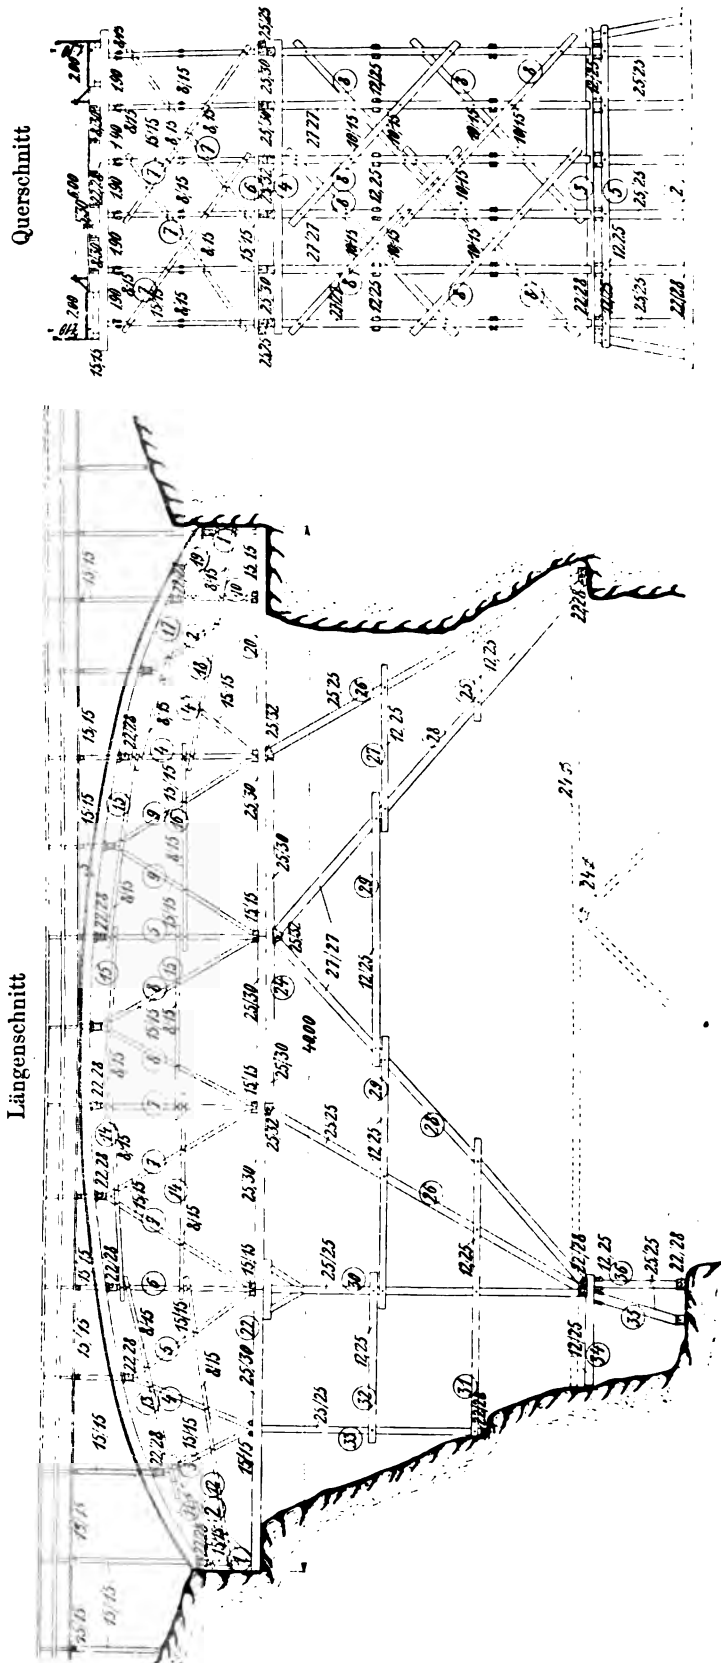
Lehrgerüst der Ennsbrücke bei Groß-Raming.
